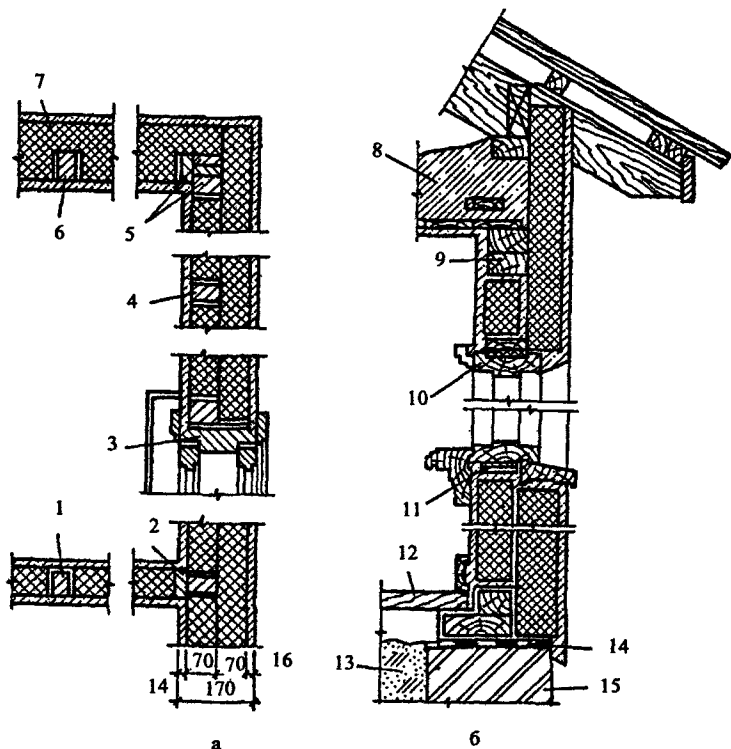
Детали конструкций каркасного дома с утеплением стен фибролитовыми плитами:
